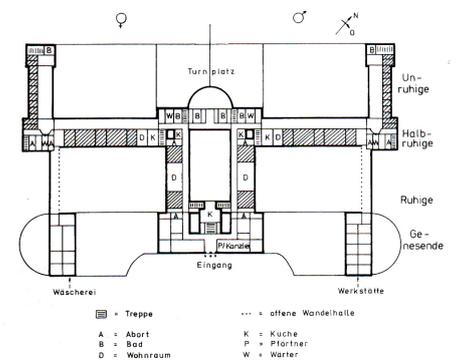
Grundriss Landesirrenanstalt Brünnefeld
